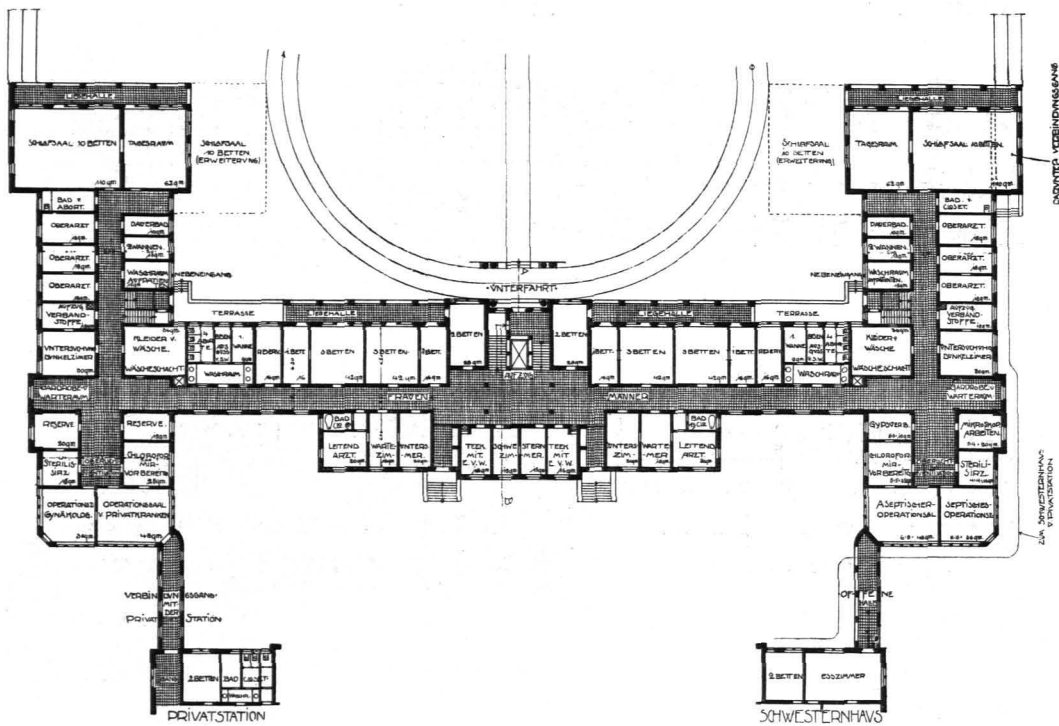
GRUNDRISSSE DER OBERGESCHOSSSE.
